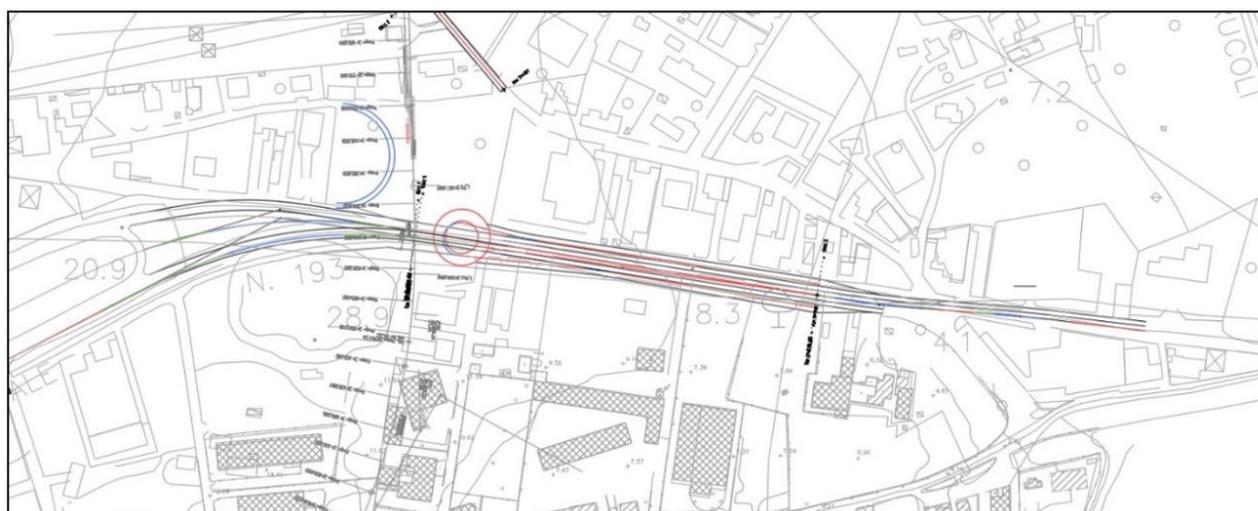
Planimetria Interferenza con SS 193 Alternativa 4
